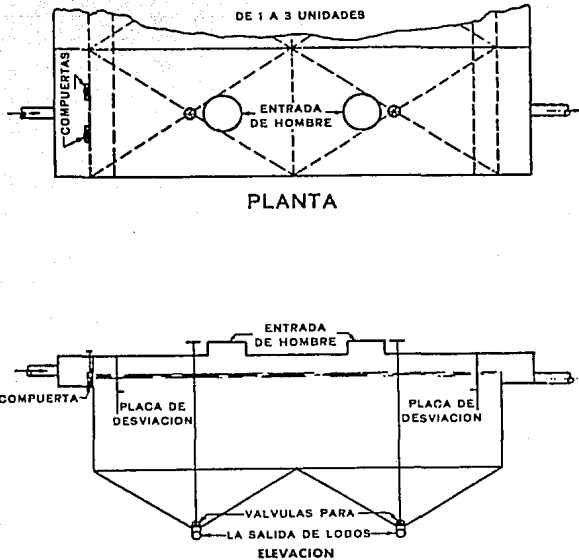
Vista en planta y perfil de una fosa séptica
